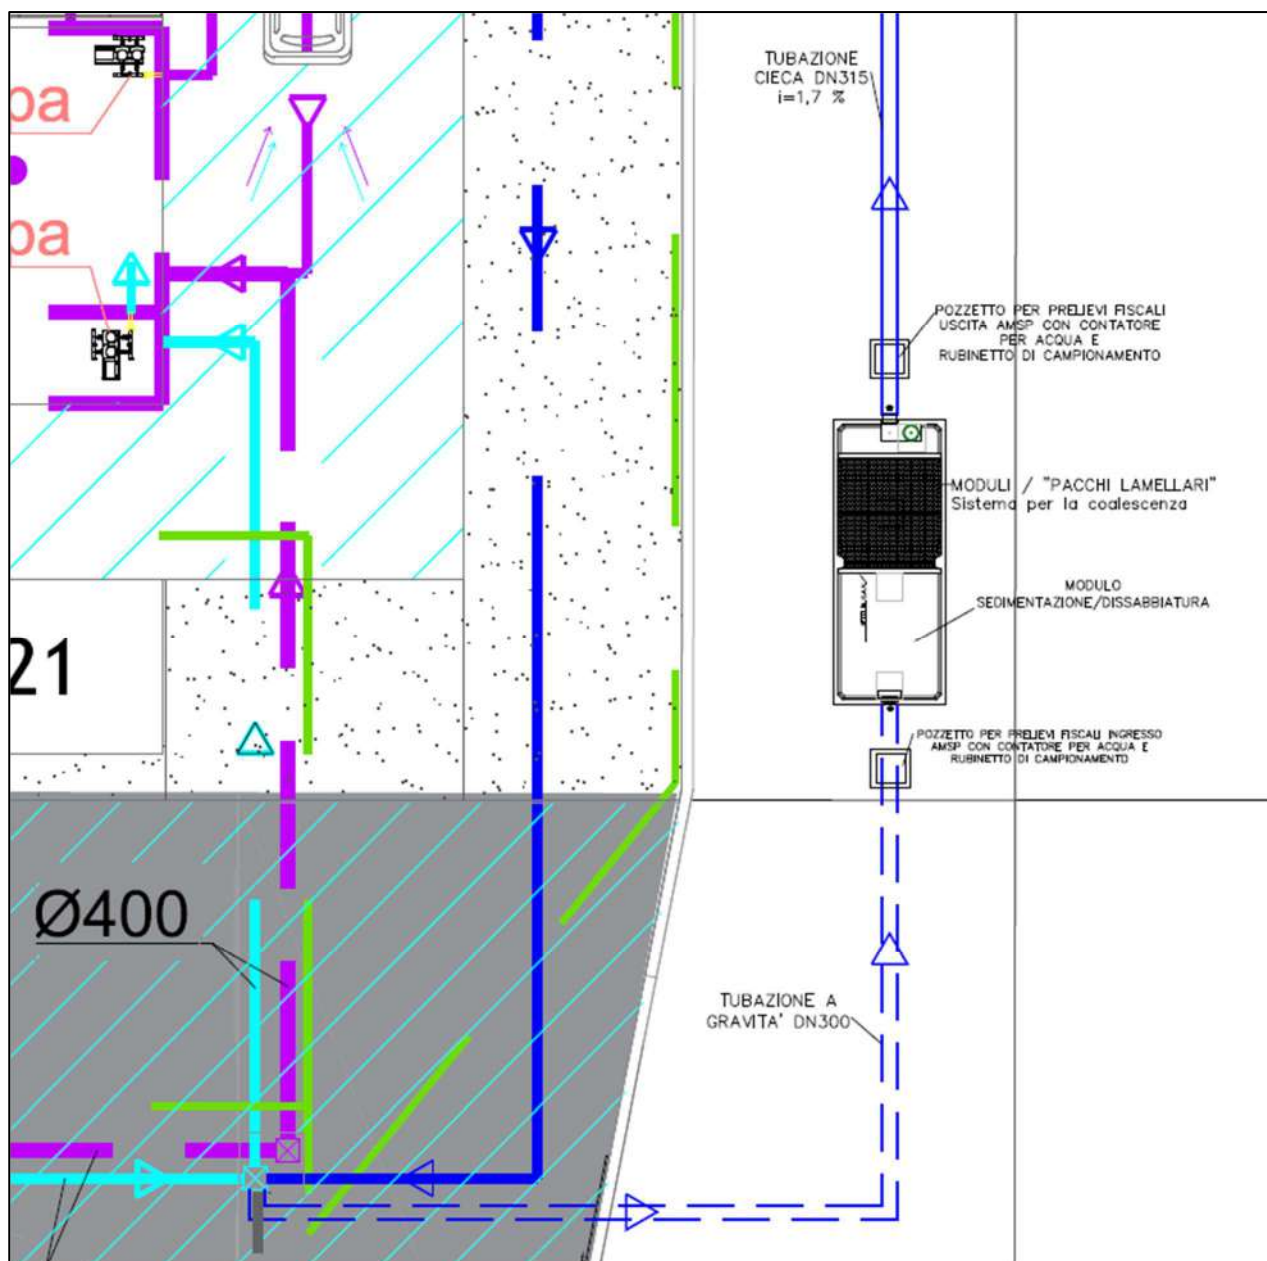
Layout impianto di trattamento acque di seconda pioggia
